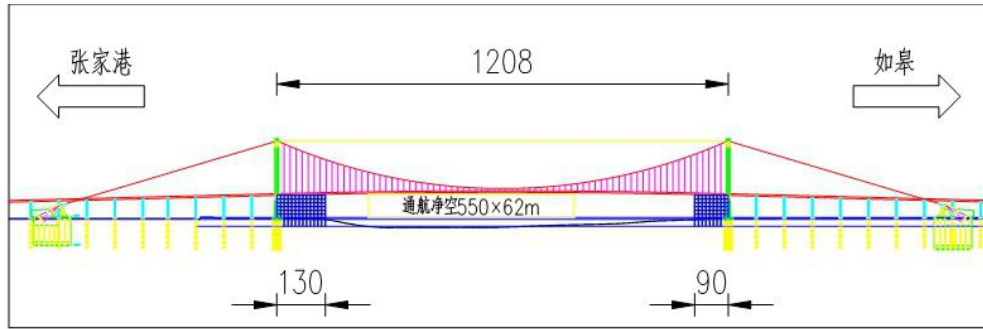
中汊航道通航孔桥临时支架总体平面布置图
